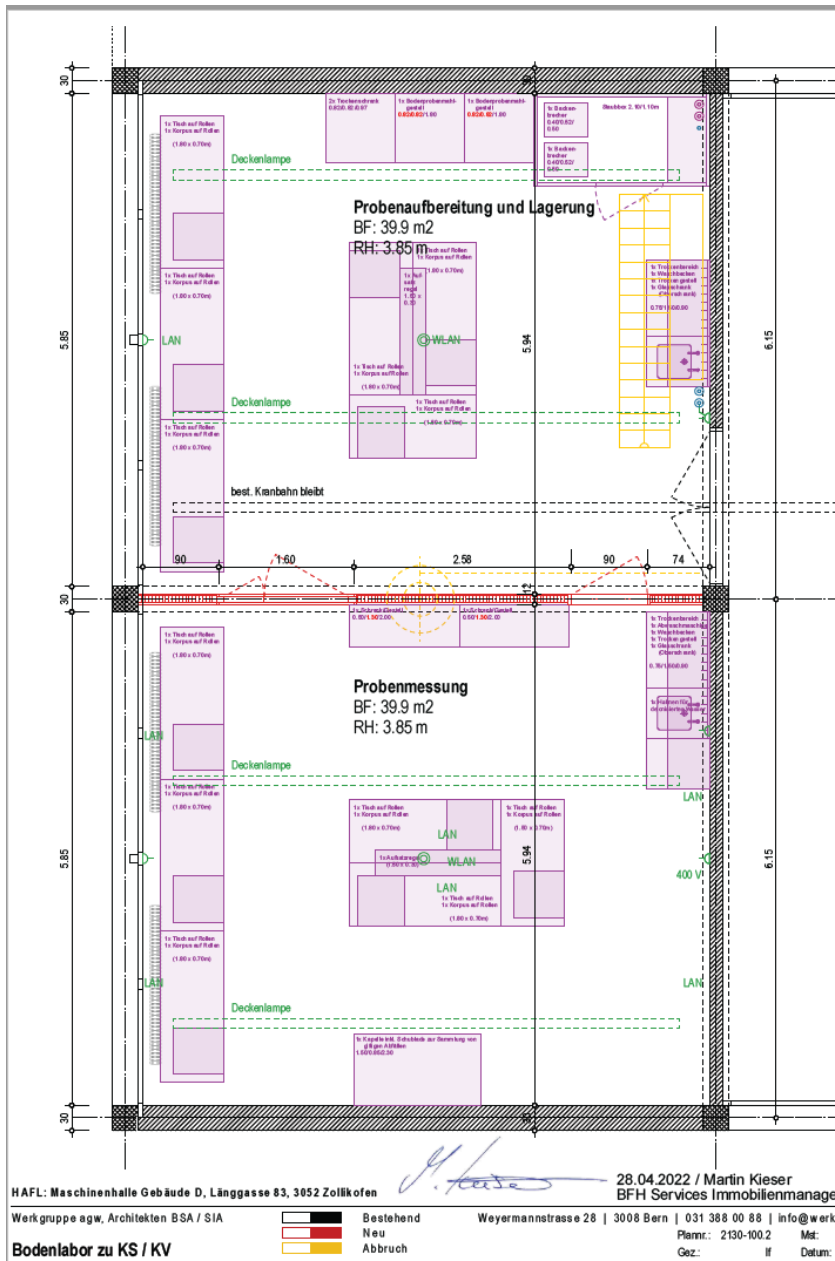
Grundriss zu KS Organisation Bodenlabor & Probenaufbereitung /-zwischenlagerung (Beilage 10)
